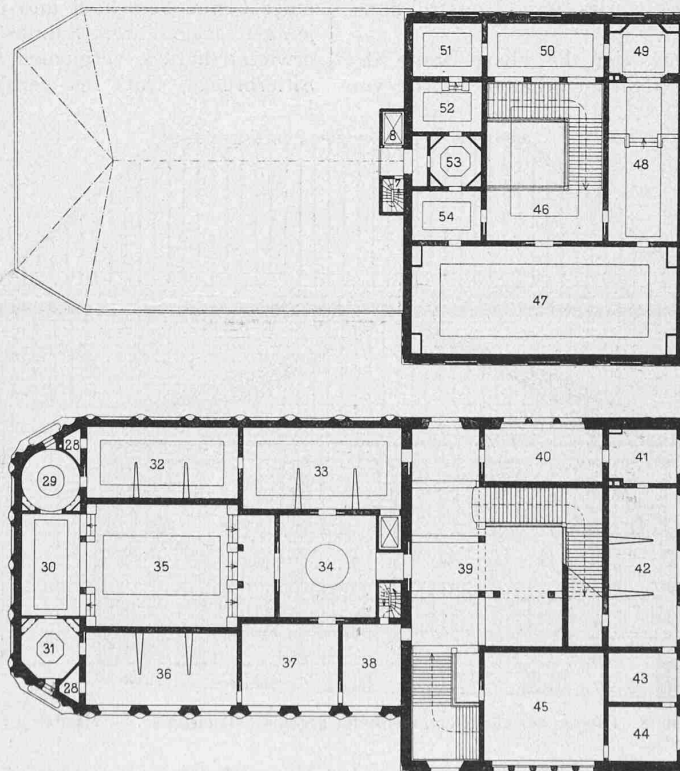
und 4. Grundrisse vom I. und II. Stock. — Masstab 1:600.
